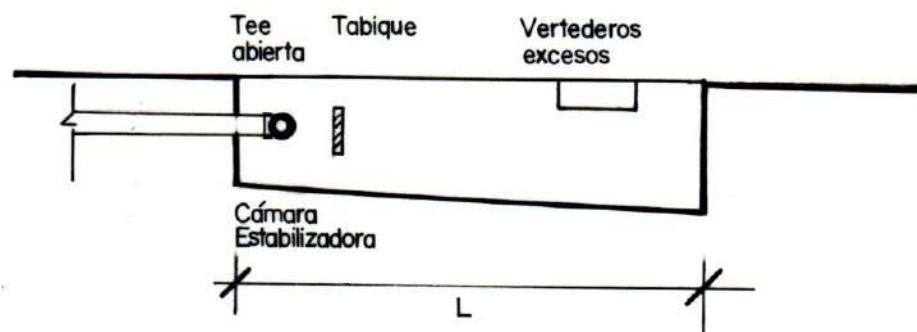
20 Desarenador con entrada en tubería a baja presión.
